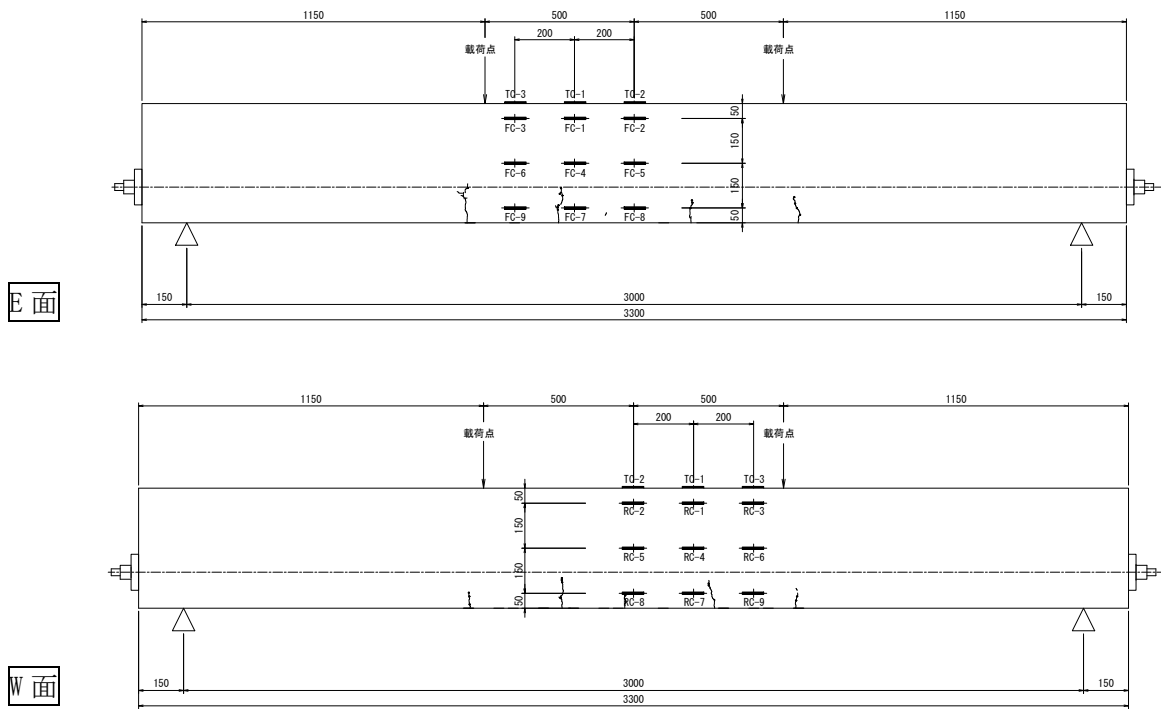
着目したひび割れとひずみゲージ位置 (C46-70)
